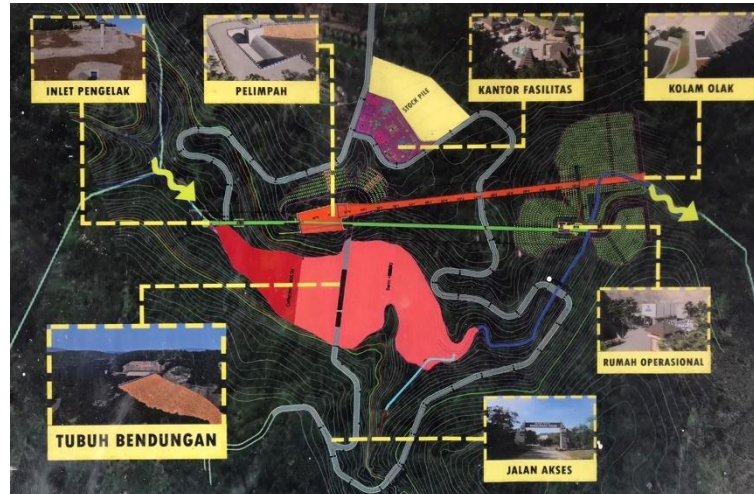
Lokasi Proyek Pembangunan Bendungan Sidan
